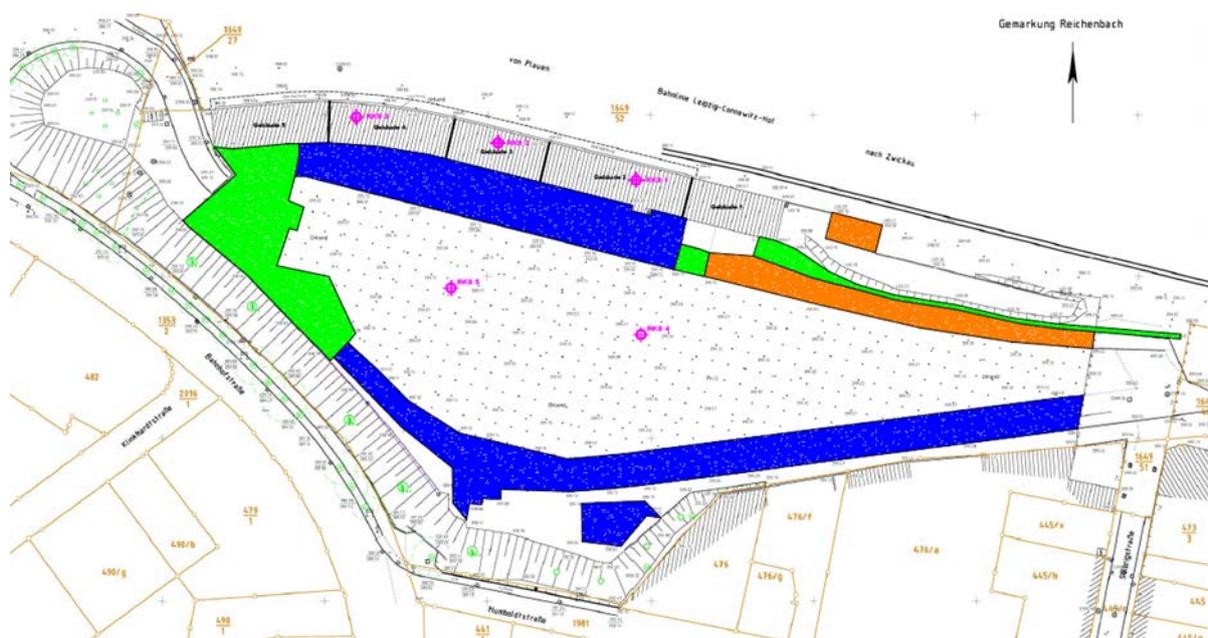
, Plangebiet vor dem Abbruch, Quelle SLG Ergänzende orientierende Untersuchung, Bohransatzpunkte
